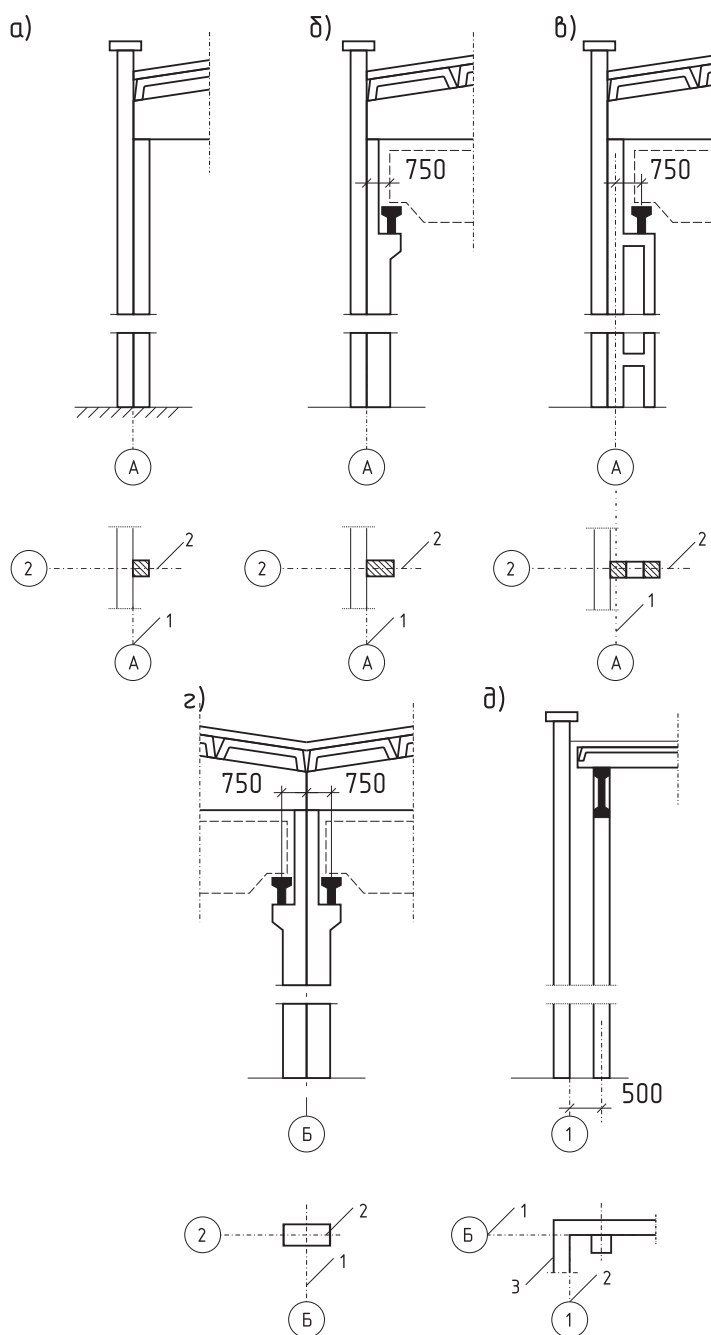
Привязка колонн каркаса к разбивочным осям здания:
